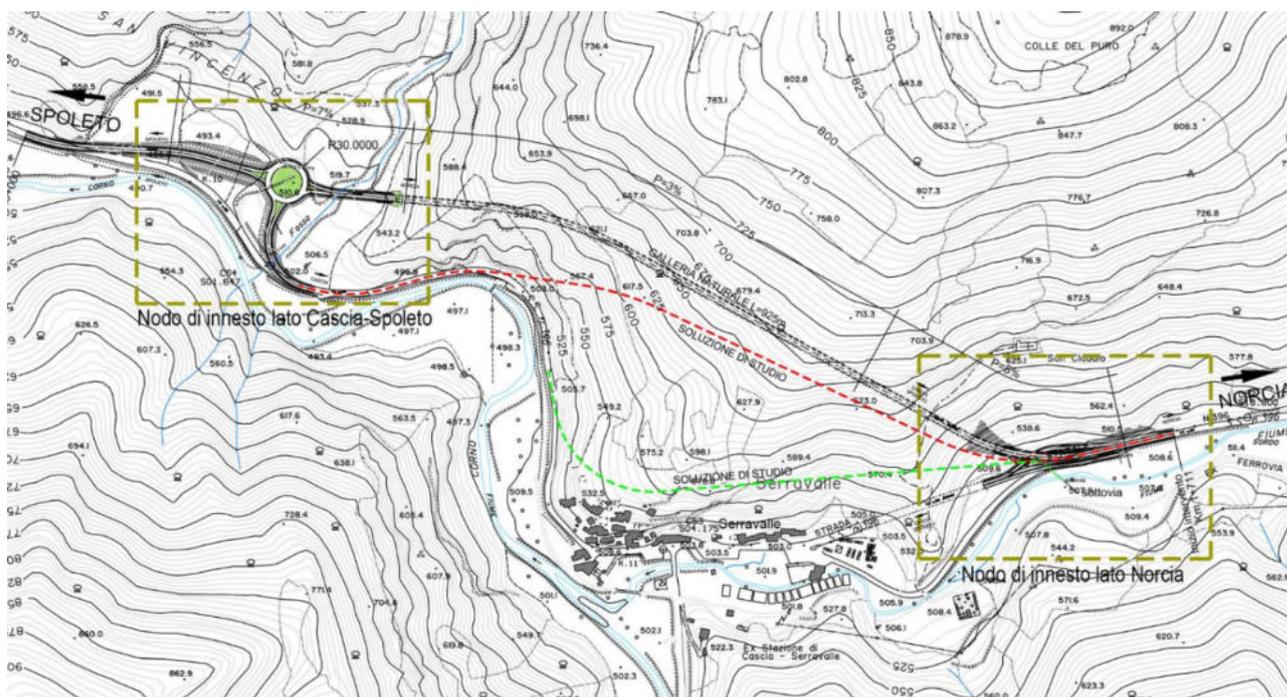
Estratto PRG, Parte Strutturale – Progetto viabilità variante di Serravalle
